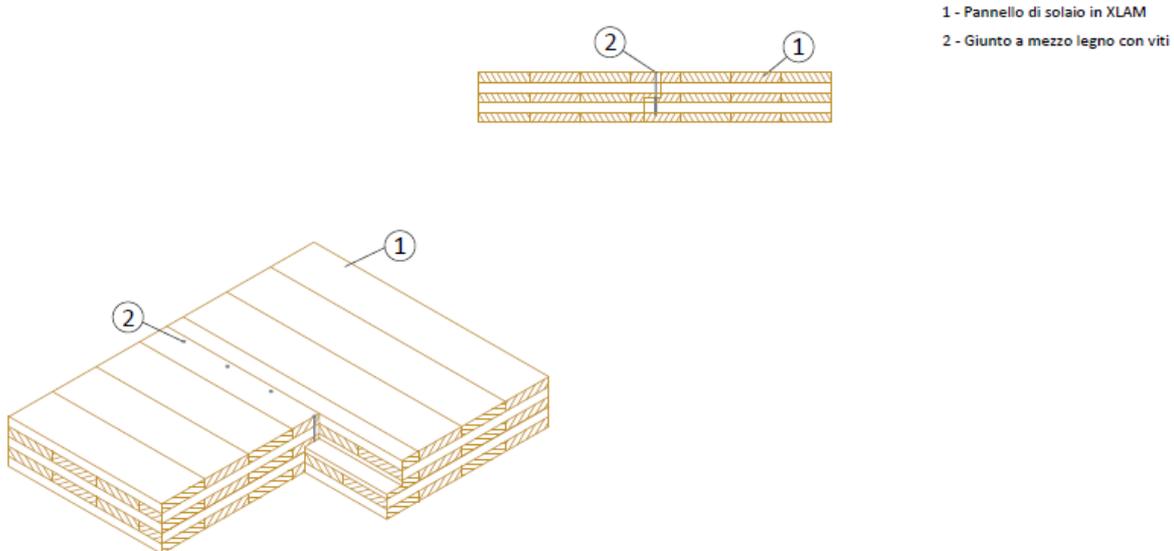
Collegamento solaio-solaio tramite giunto a mezzo legno con viti di ancoraggio
